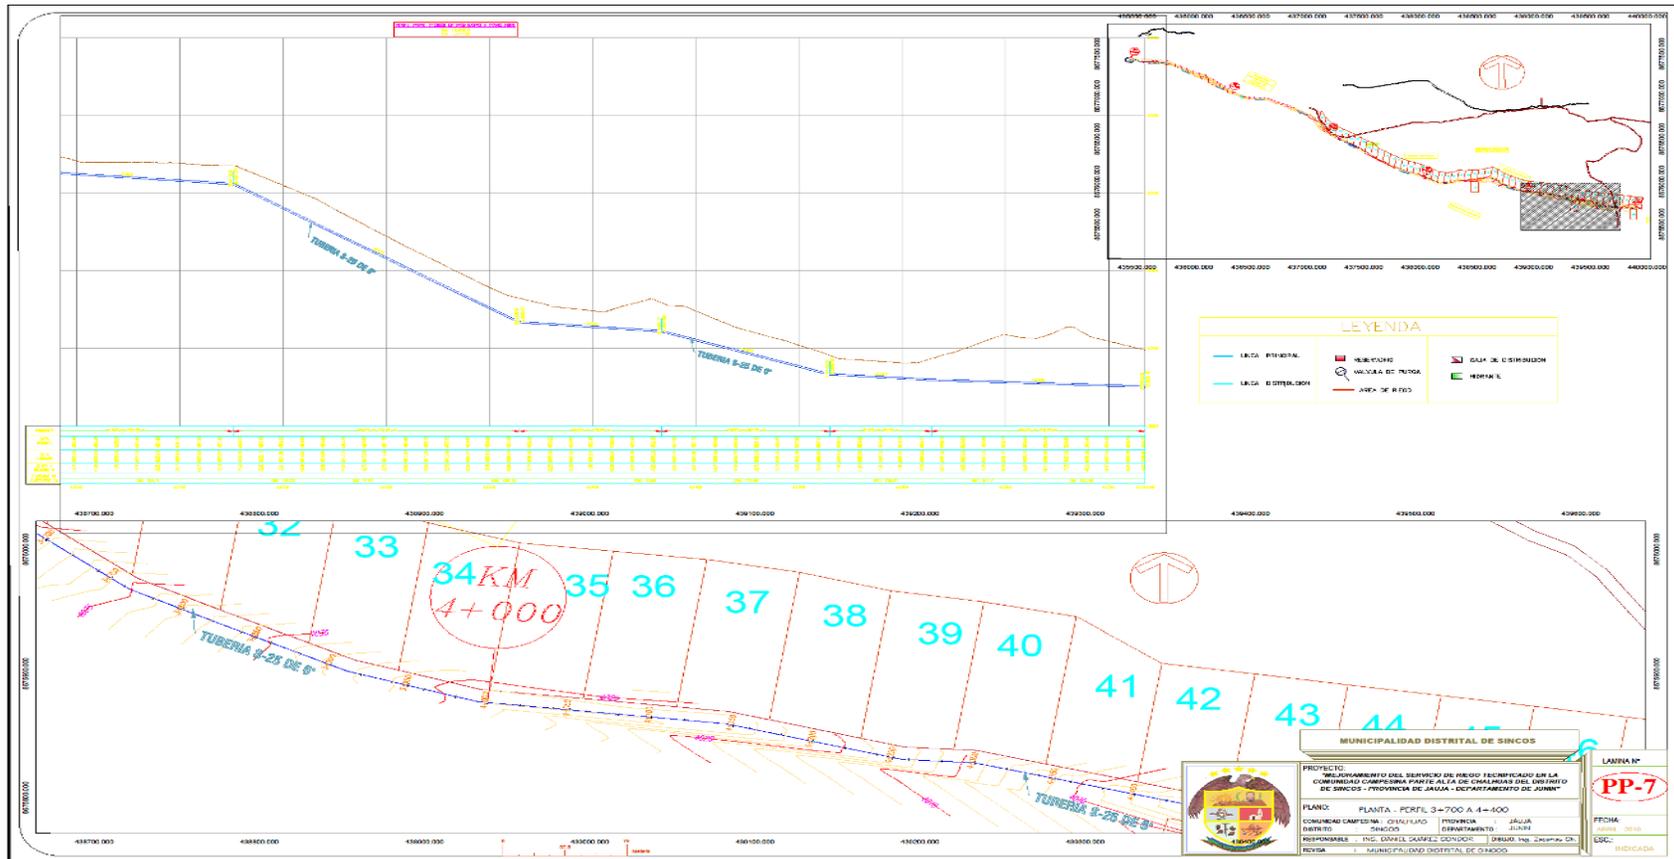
Plano de planta - perfil de canal Prog. 3+700 a 4+400.
